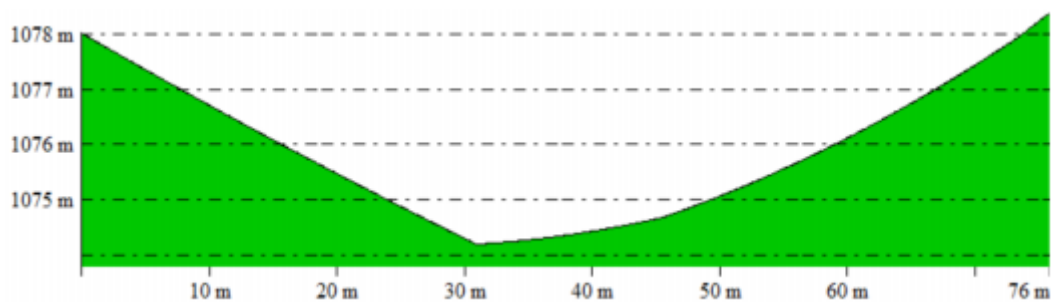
Perfil de la zona donde se construirá la presa. Fuente: Proyecto de reconstrucción de presa de Project Zimbabwe
